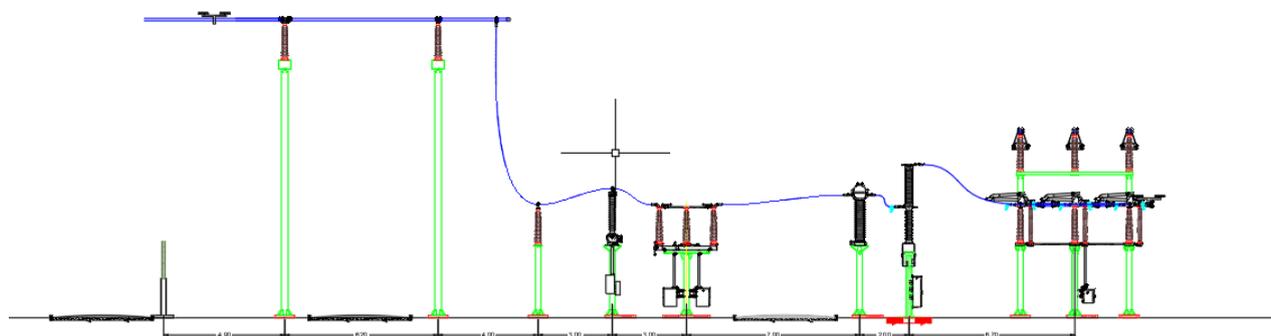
sezione futuro stallo di arrivo in Stazione Elettrica RTN
